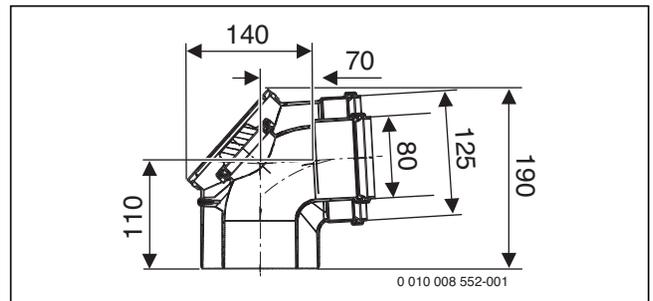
Konzentrischer Bogen mit Prüföffnung Ø 80/125 (Maße in mm)
